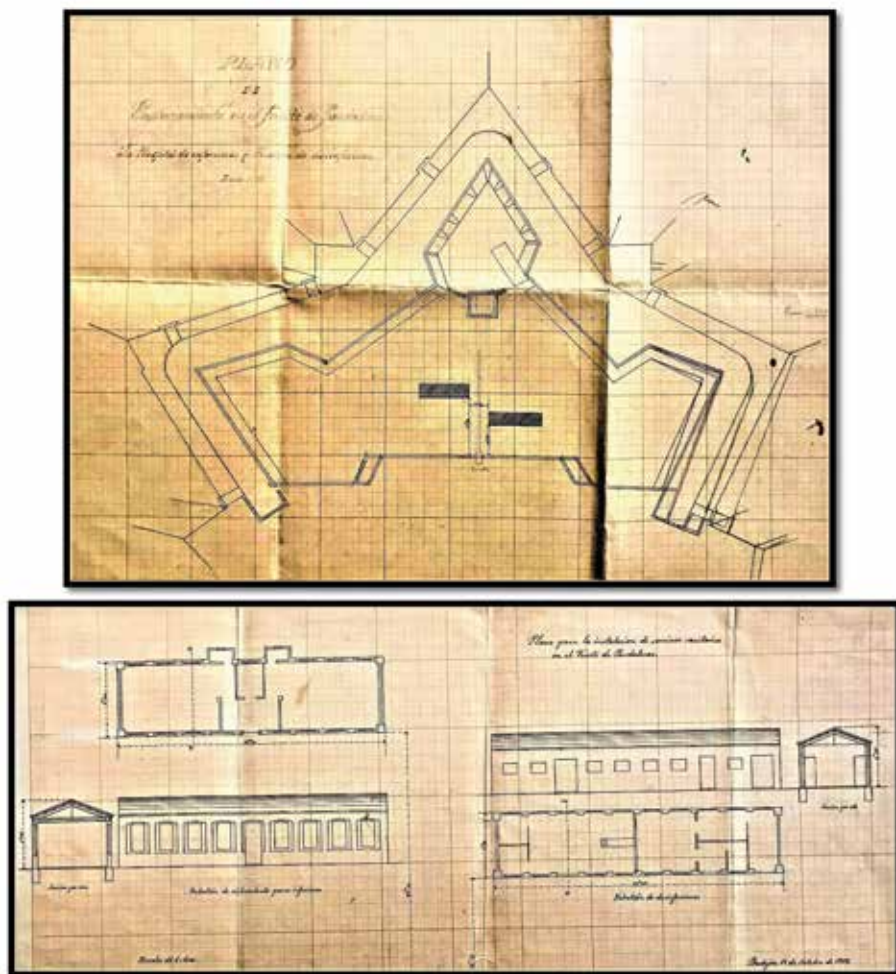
y 379. Plano de la ubicación y proyecto del hospital de infecciosos y pabellón de desinfección. Fuente: Sección de vías y obras año 1913.
